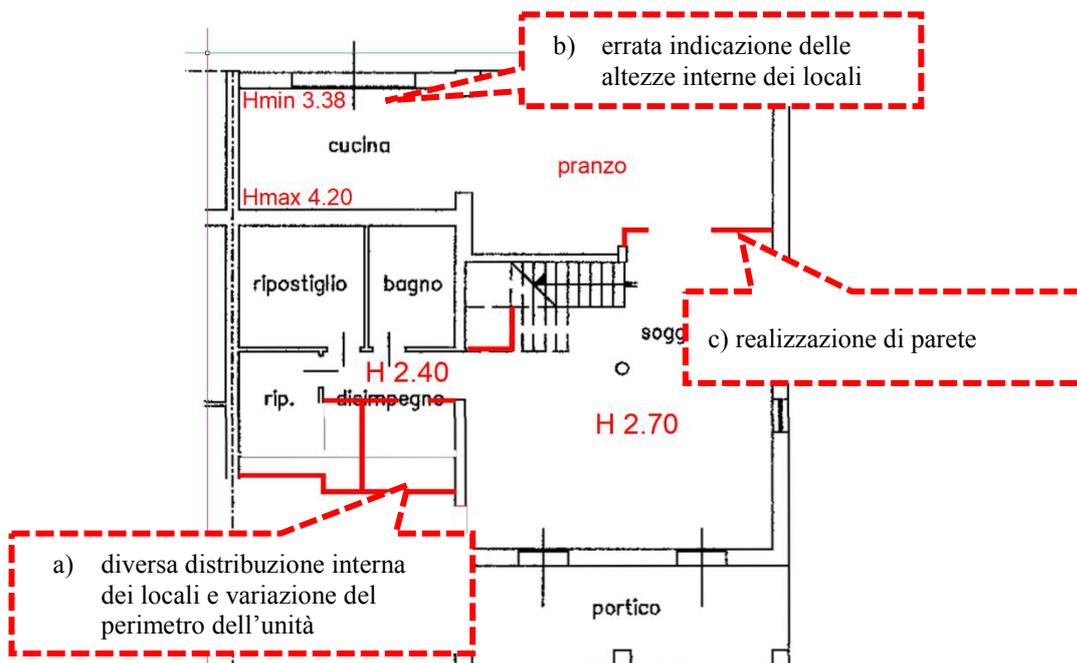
Estratto planimetria catastale del piano terra con indicazione delle difformità
